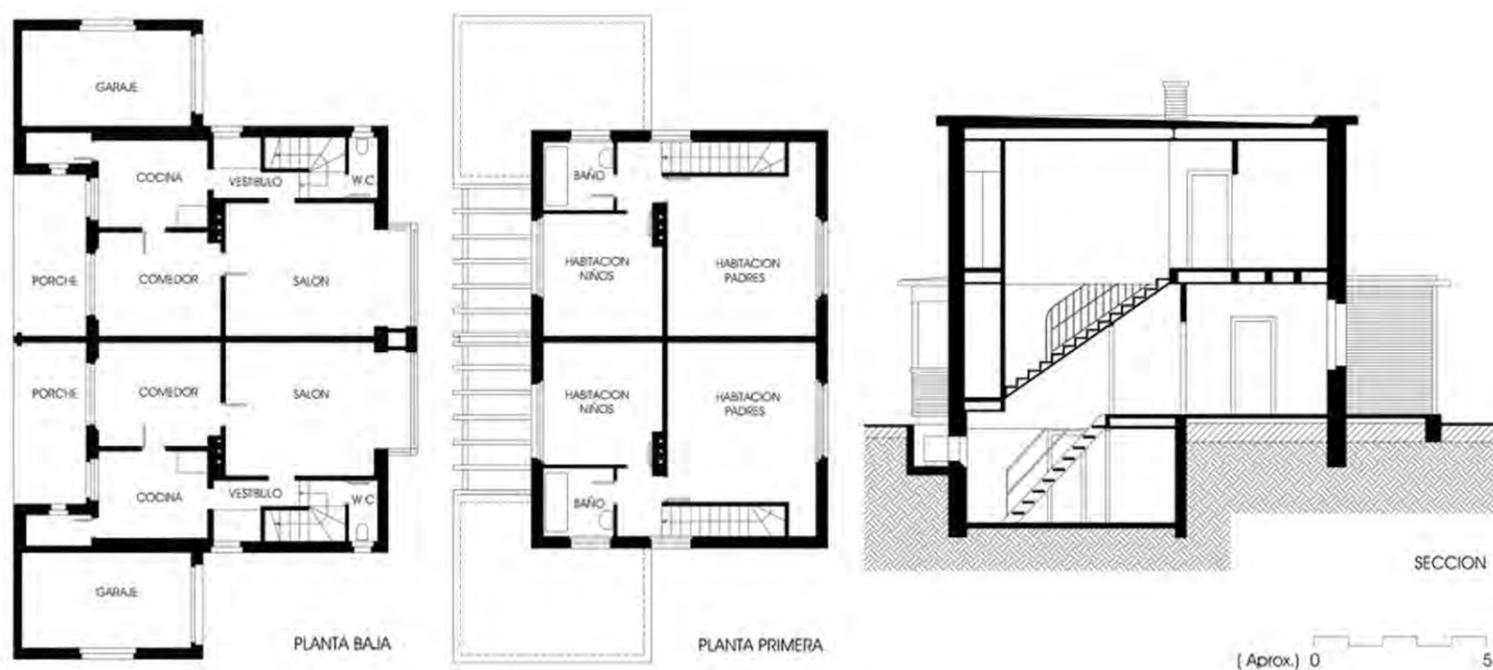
Plantas y sección de las viviendas pareadas anteriores de M. Drofa (dibujo del autor).
